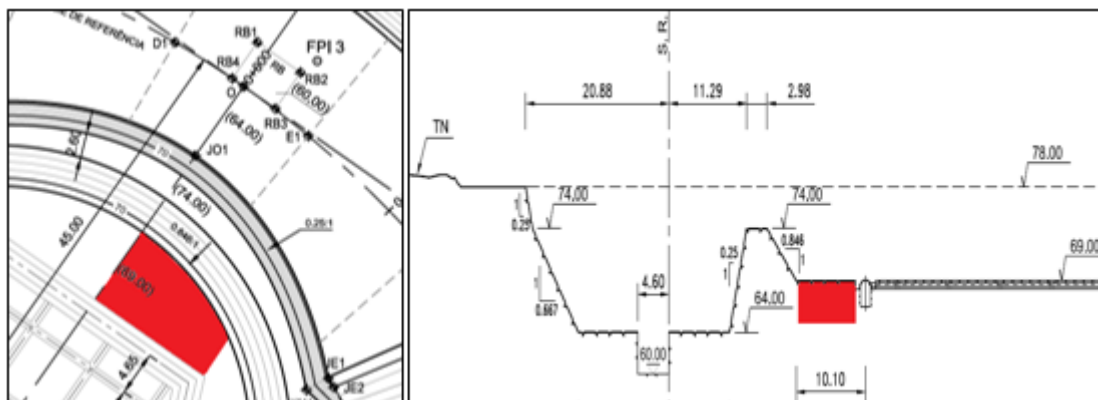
Local onde foi realizada a perfuração do terceiro ciclo de afiação (assinalado a vermelho); Esquerda – Planta parcial da bacia de dissipação e a escavação da barragem; Direita – Perfil entre a escavação da fundação da barragem e a vala de drenagem da bacia de dissipação (adaptado de Bacia de dissipação – Contenções. Planta 10-10E, pormenores), EDP – Gestão da Produção de Energia, Maio 2011).
